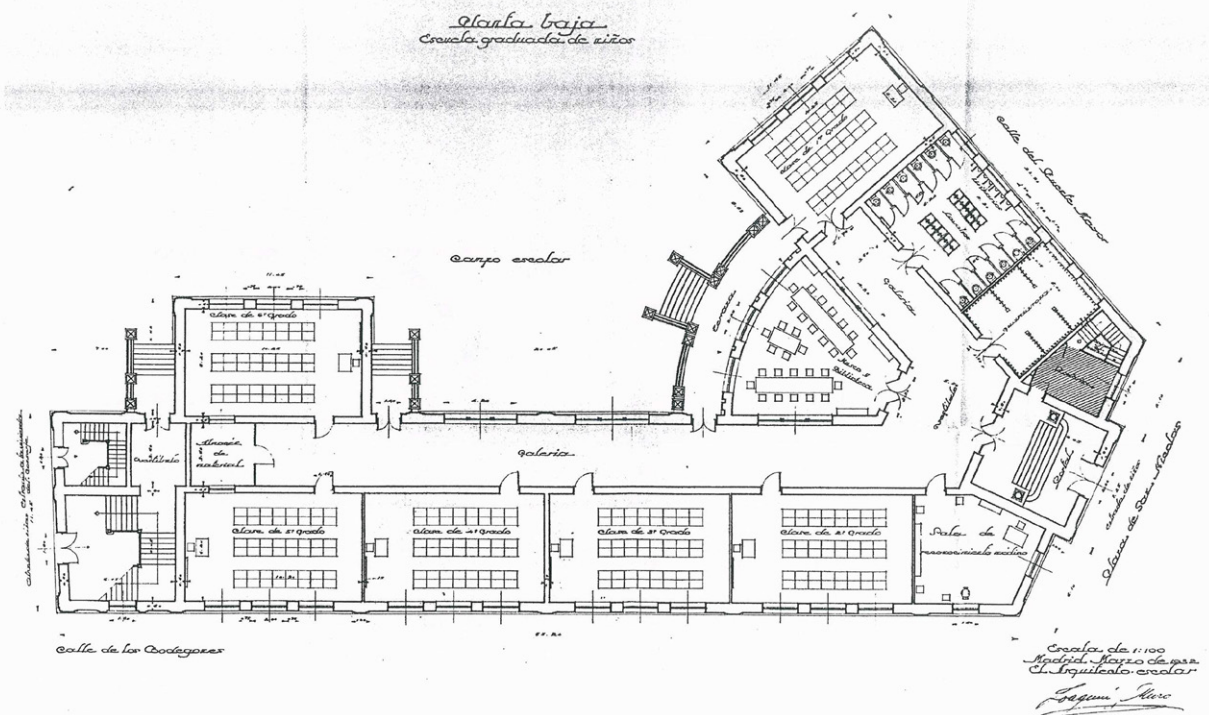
2. Planta baja del centro escolar. Imagen extraída de (Rodríguez 2008).
